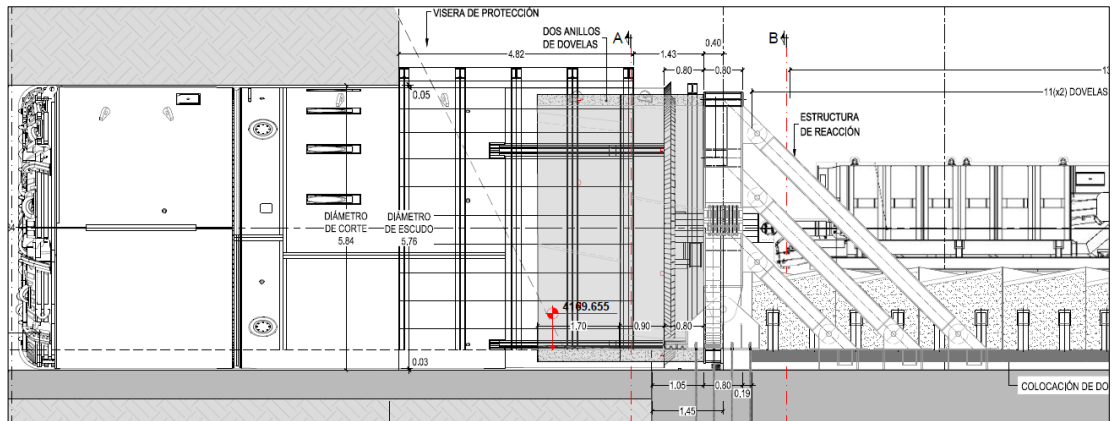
Vista de perfil de la estructura de reacción (Fuente: Expediente Técnico Final)
